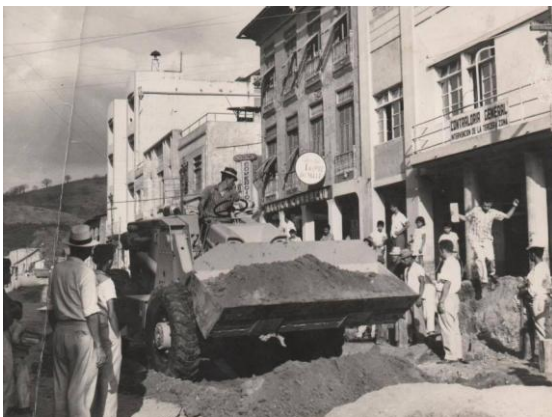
Maquinaria trabajando en la calle Córdova, 1967 (Arturo Espinoza)
